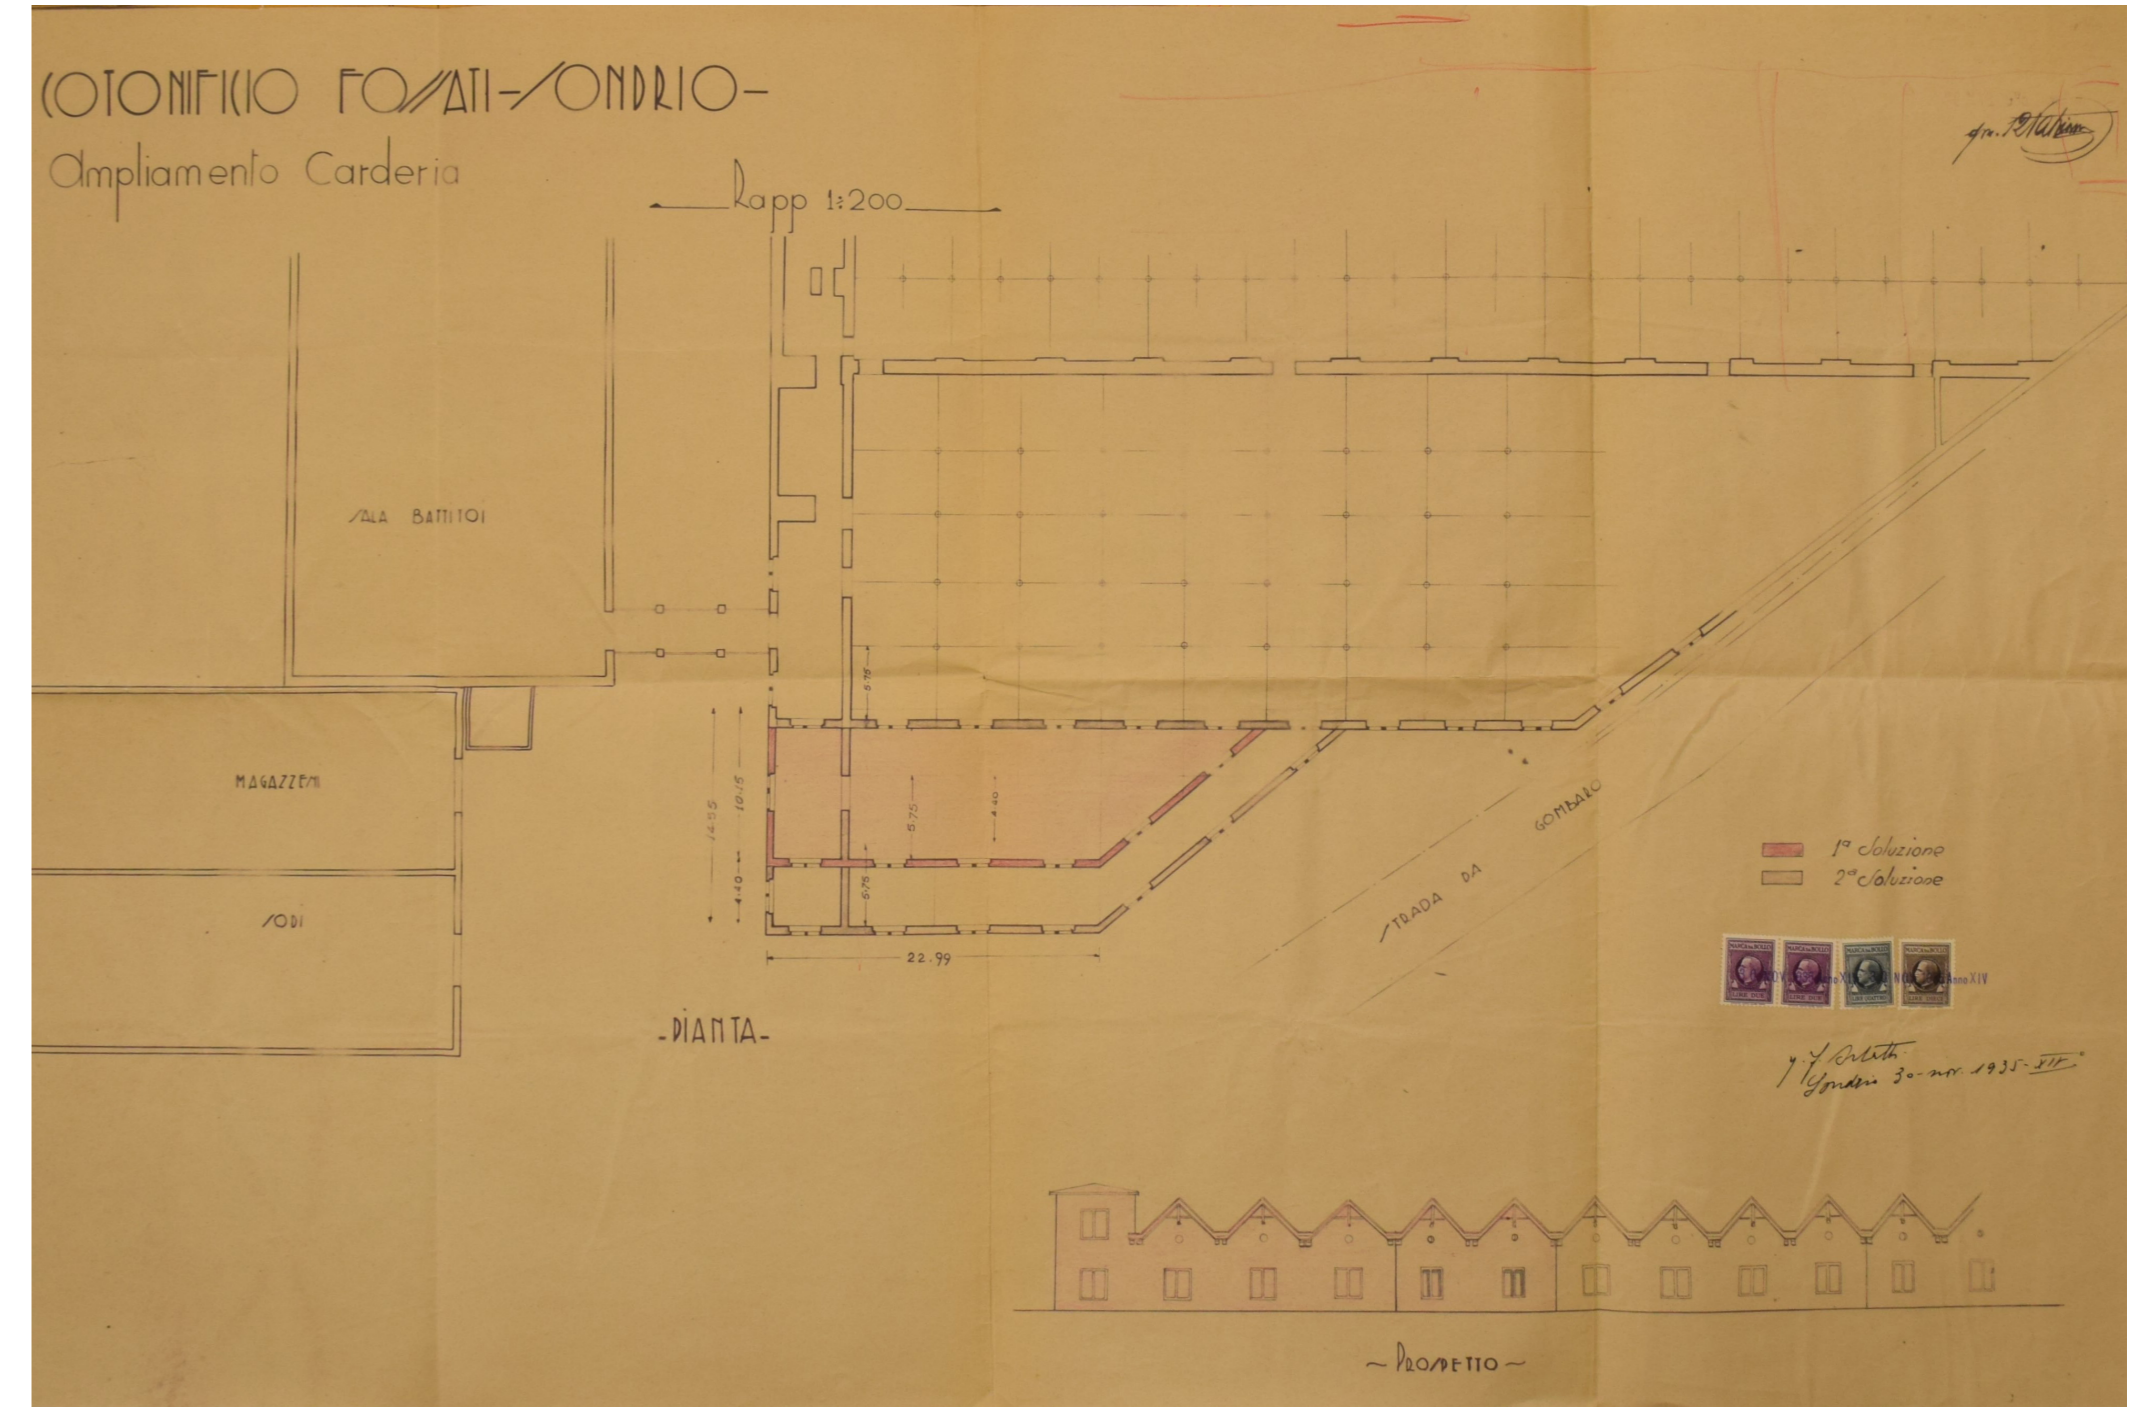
Edifici 4 e 5, pianta e prospetto su strada, ampliamento, 1935, tavola visionata all'Archivio statale di Sondrio
